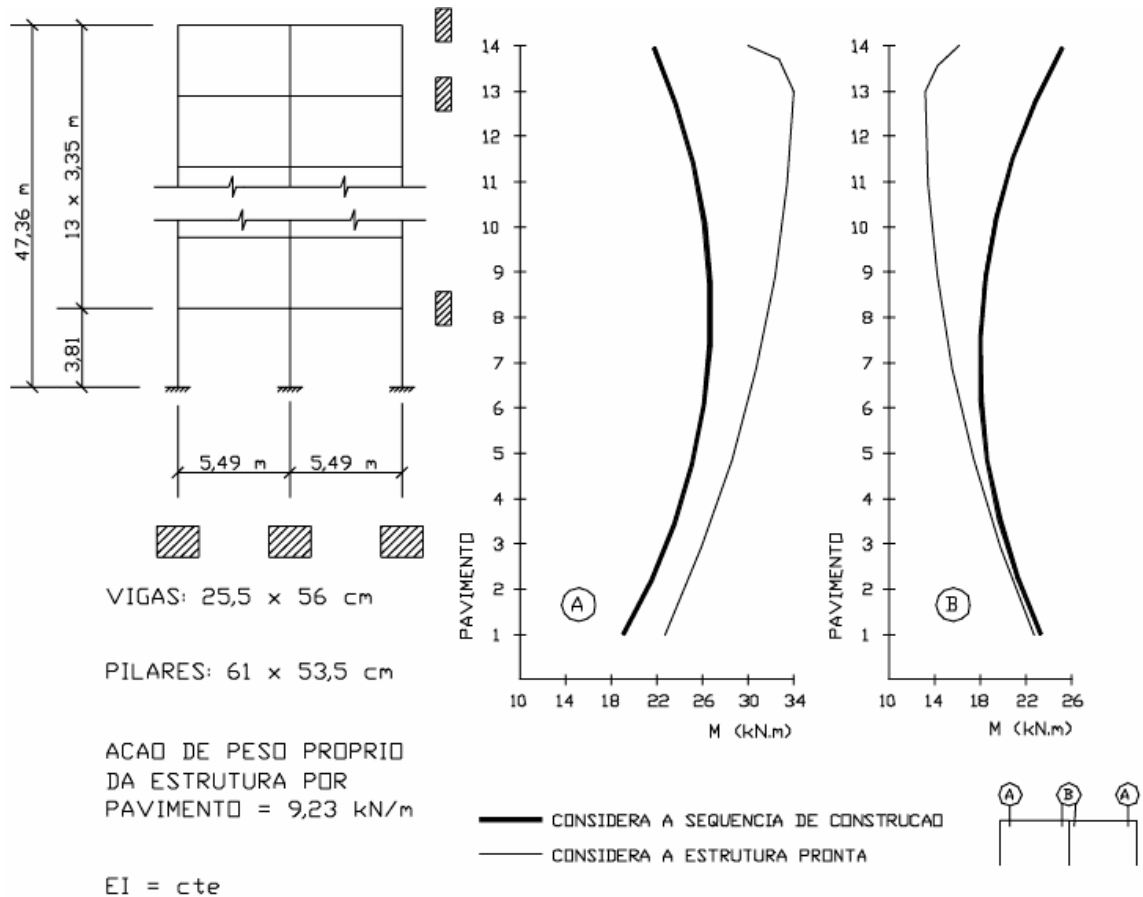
pórtico plano submetido à ação de peso próprio da estrutura.
